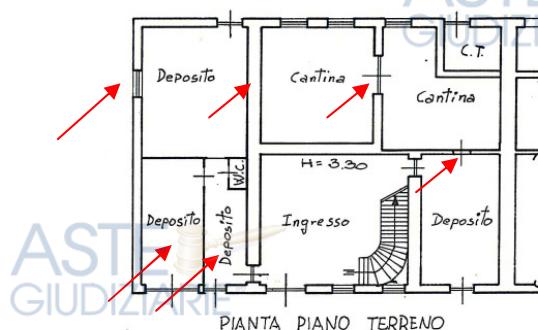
Estratto Planimetria catastale attualmente in banca dati prot. n.T130060 del 06.03.1989
